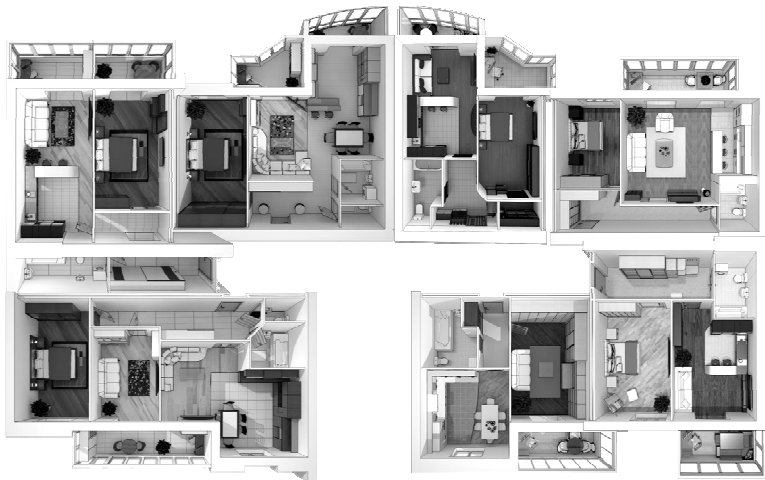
Приклади перепланування квартир житлового комплексу «Набережний квартал»
